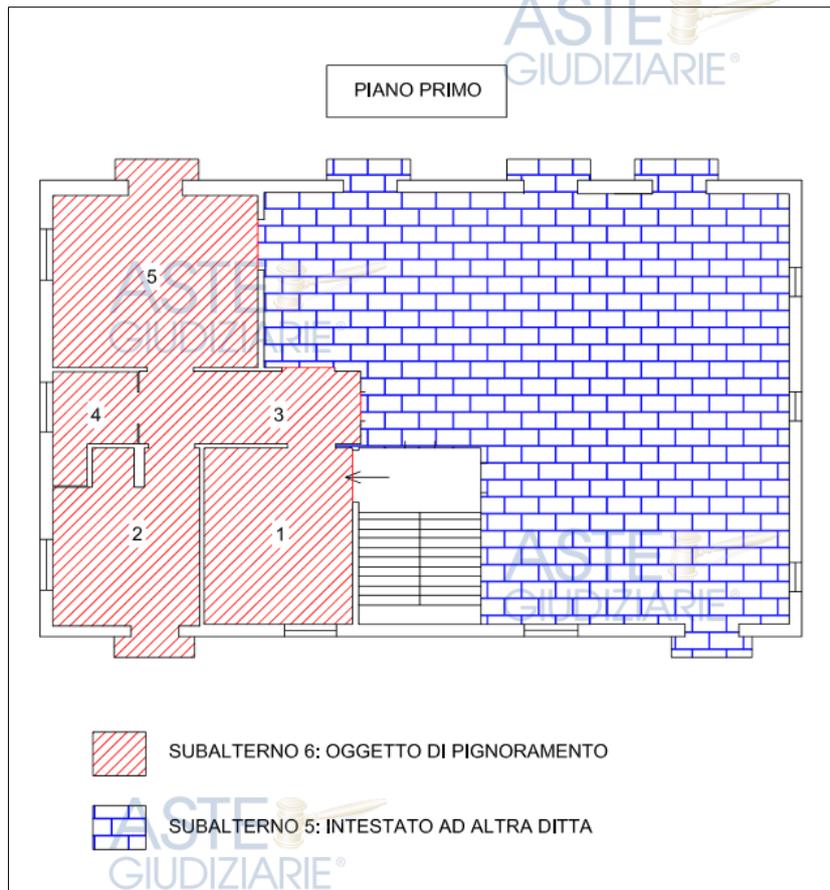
Planimetria dello stato di fatto del sub 5 e del sub 6 posti al piano primo
